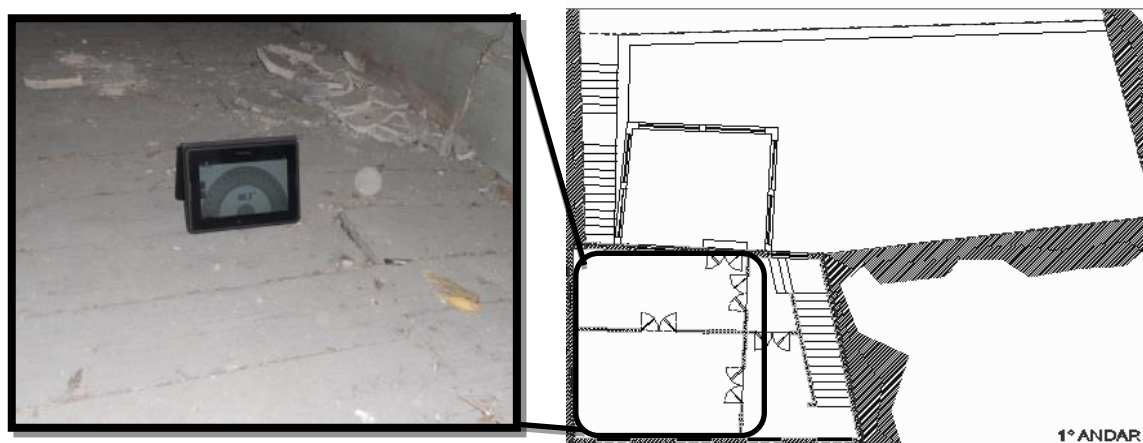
Anomalia 11 - Fotografia e localização em planta
